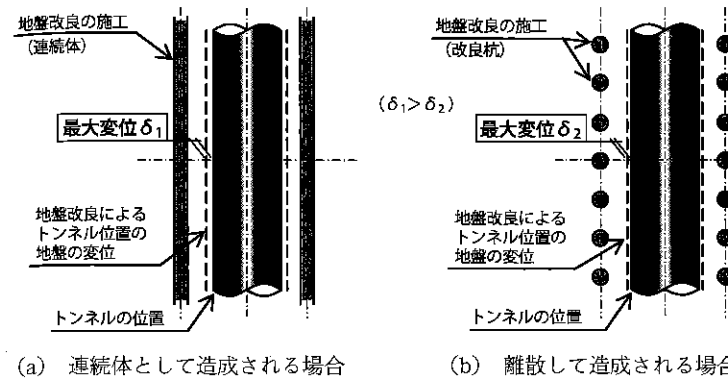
地盤改良の施工と地盤変位量の平面解析モデルの概要
